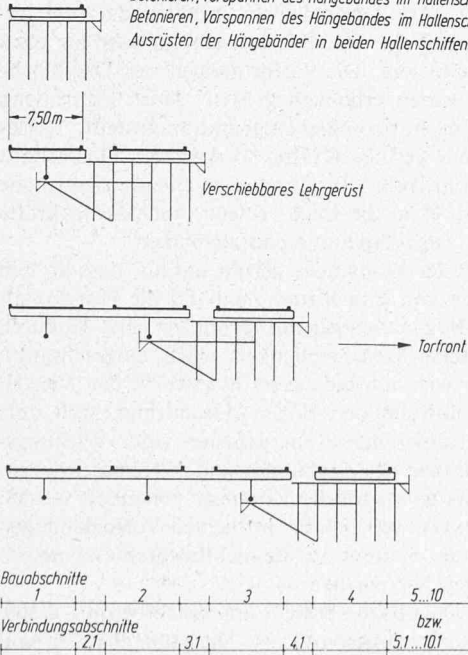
Wartungshalle V, Frankfurt, Schema der Bauausführung der Dachfläche in 10 Bauabschnitten
